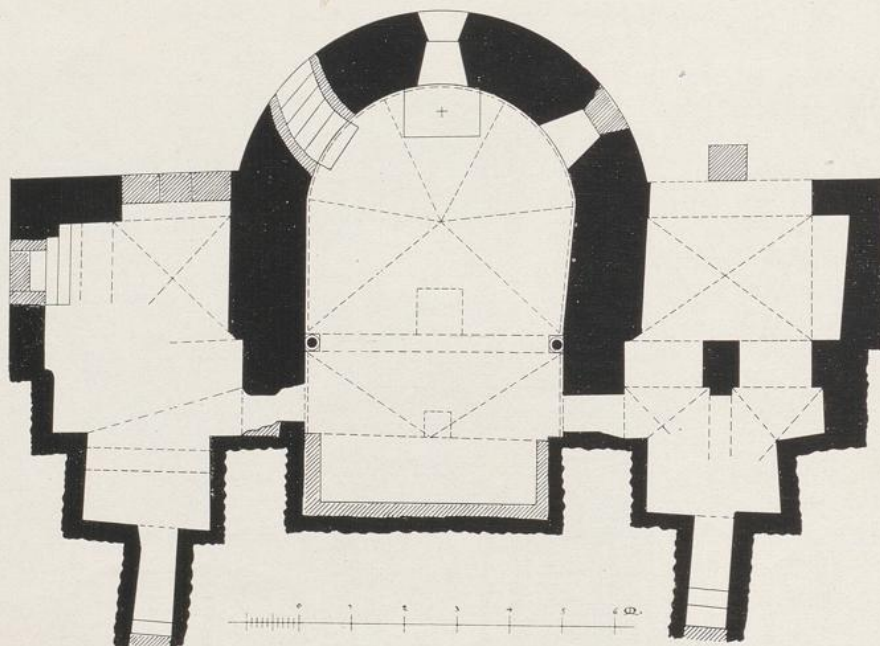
St.-Maria-Lyskirchen. Grundriss der Krypta.
